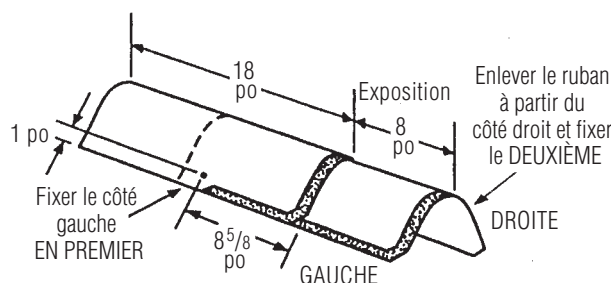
Pose de bardeaux Shangle Ridge® sur les arêtes et les faîtes.
